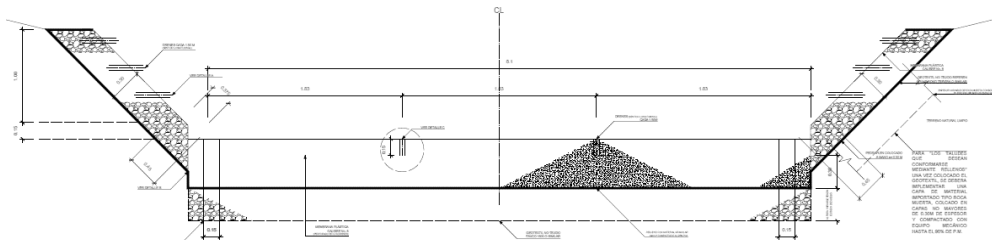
Planteamiento general del proyecto El Cairo²⁴.
